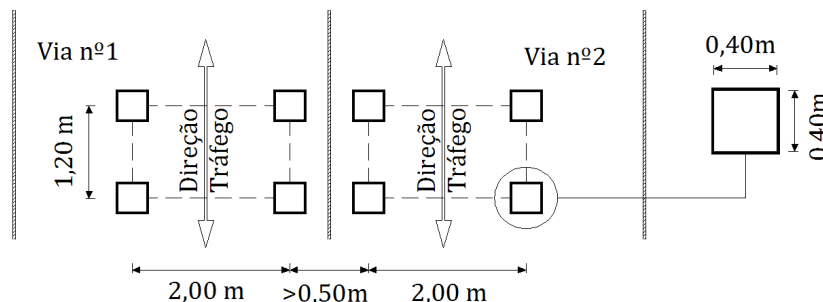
Disposição dos veículos em planta no caso de verificações locais (EC1)
